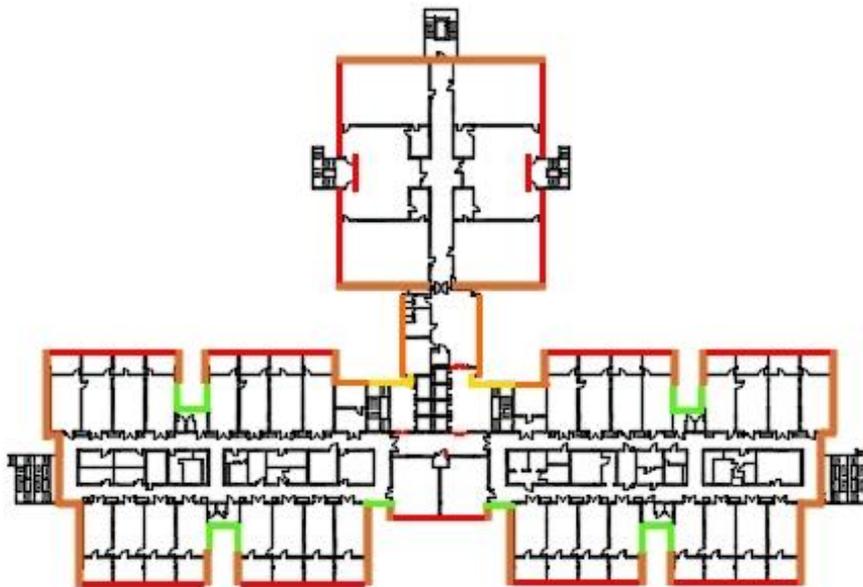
distribuzione perimetrale delle pareti dei piani 1°-6°
